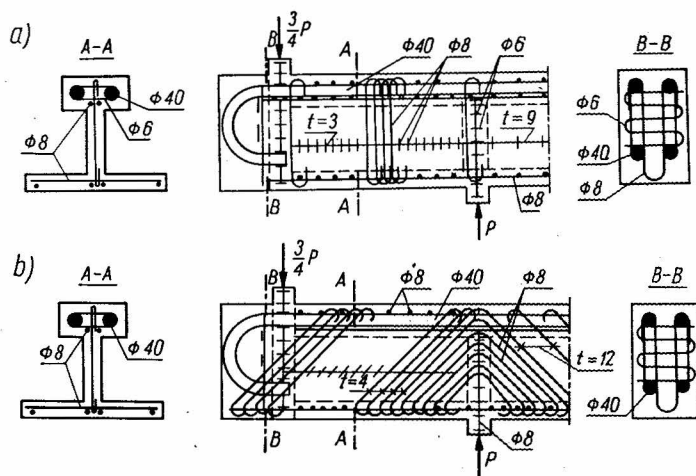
Armature des poutres dans les essais de ROBINSON [70] :
